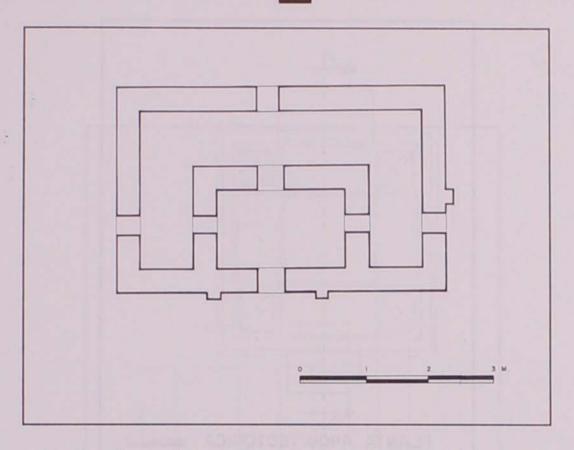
Planta en la que se observa la distribución espacial de la estructura.
